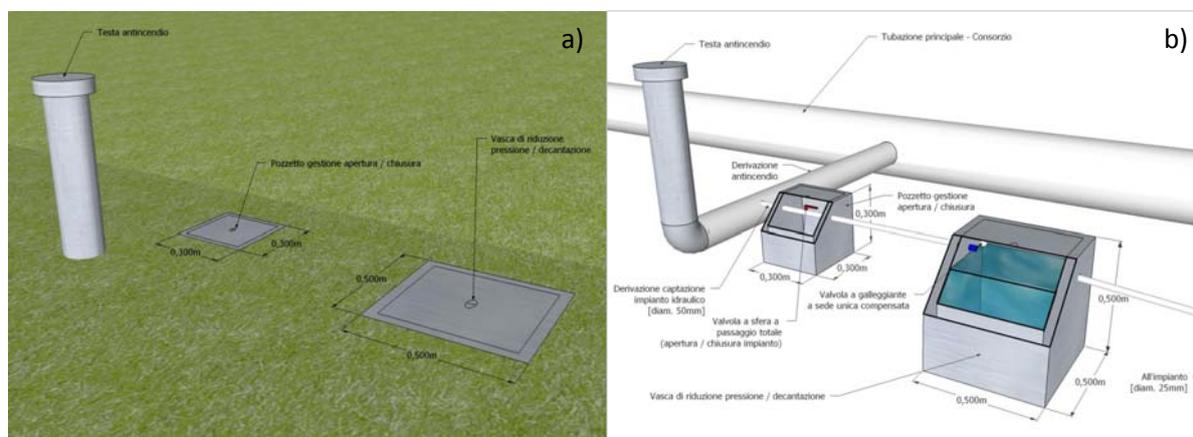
Progettazione impianto idraulico a partire dal punto di presa del Consorzio irriguo e di miglioramento fondiario Rio Moletta, in località Campo Piano: a) opere fuori terra e b) opere interrate (sezione).
